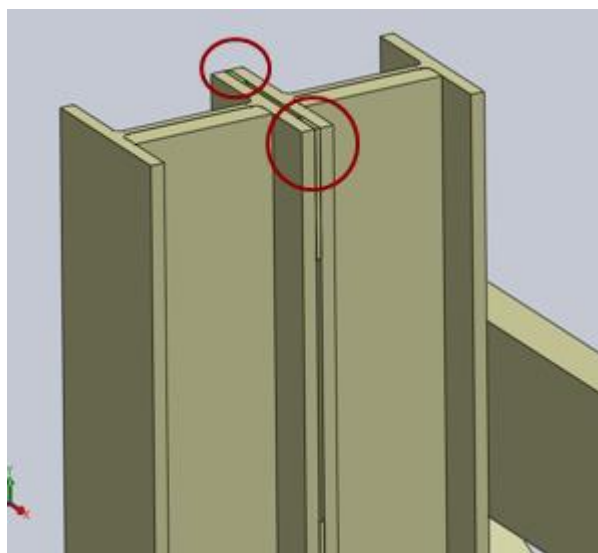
Vista em detalhe da soldadura entre os dois perfis
